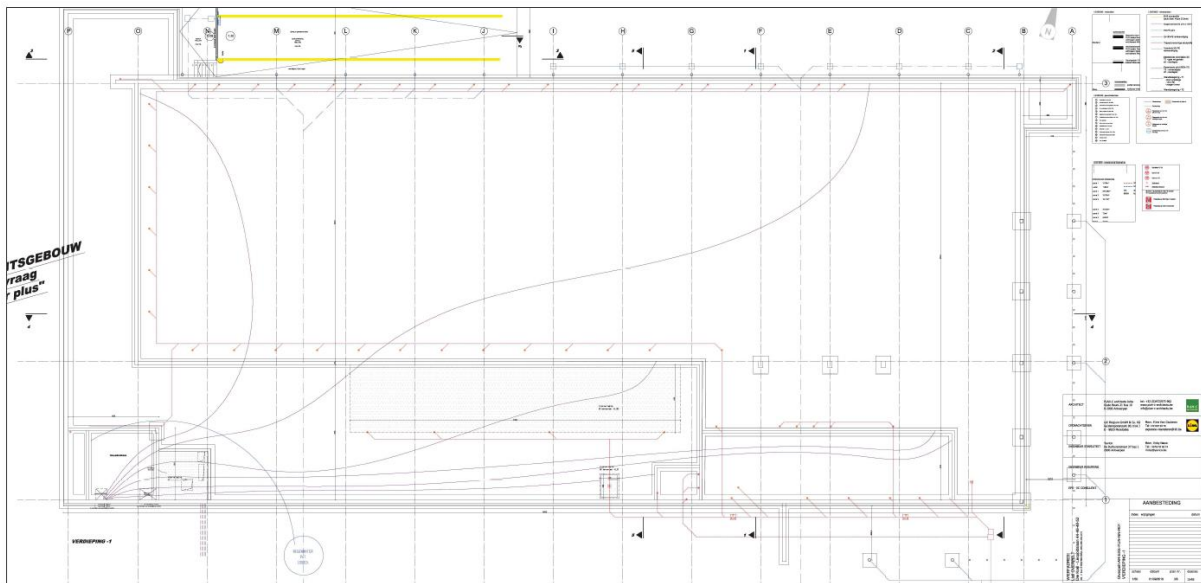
Verdieping -1 (funderingsplan) van het winkelcomplex zoals aangereikt door de bouwheer © Lid'I
